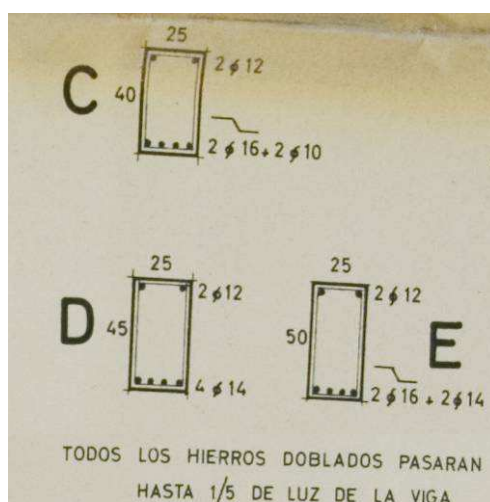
Detalle de sección de armado de vigas. Edificio ficha 189C. 018, 1963.
